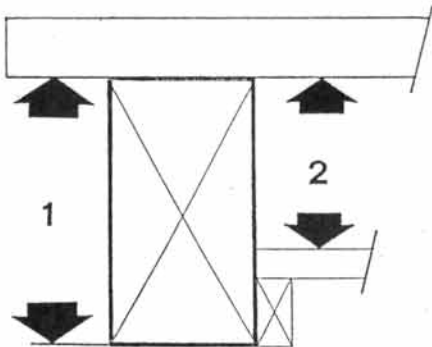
Hauteur des poutres (1) et hauteur du canal (2).
